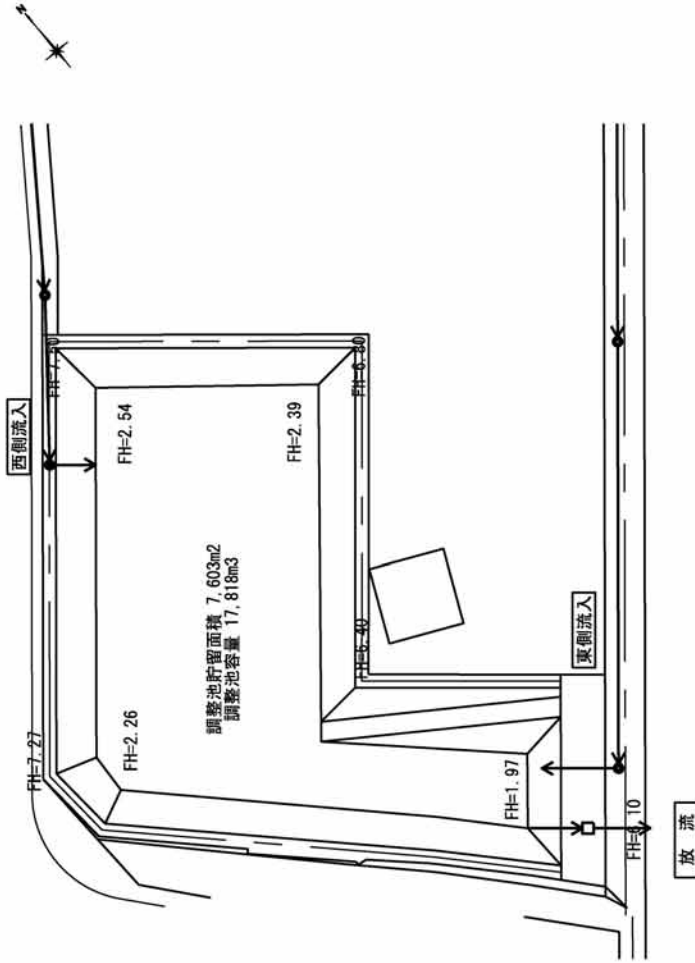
(1) 調整池計画平面・断面図 (第1調整池) 【評価書】
